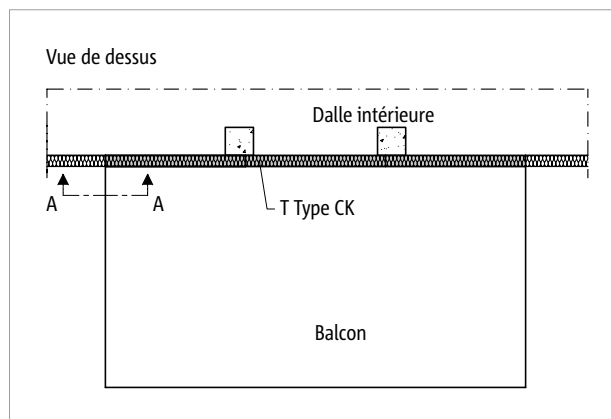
Schöck Isokorb® T Type CK : emplacement de la section A-A
